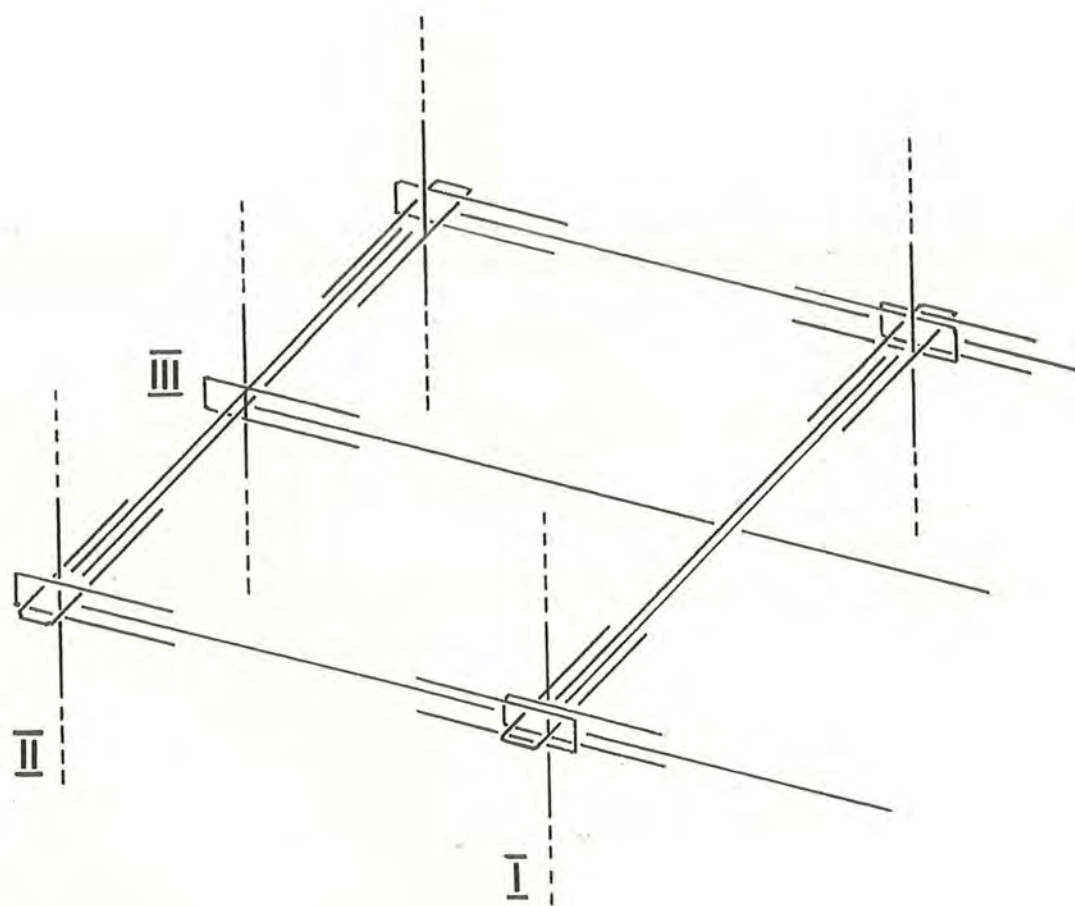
Facade-/gavlhjørne til facaderne vist i figur 422-425.
